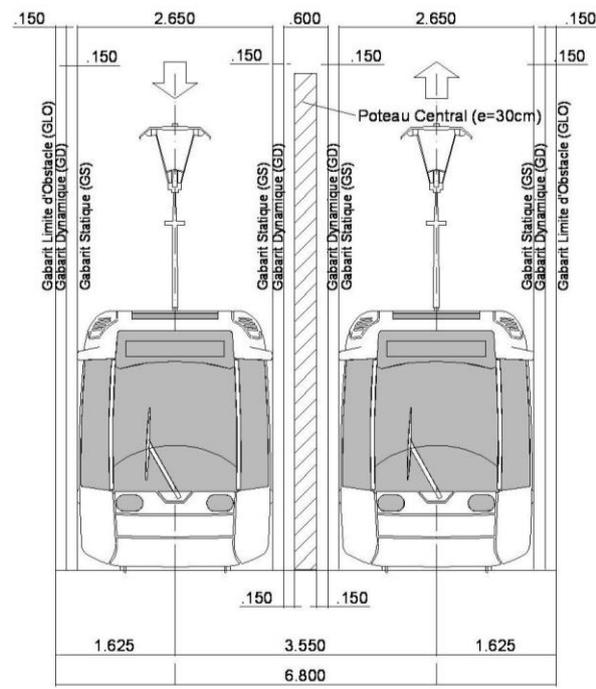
Coupe transversale du tramway en voie double avec poteaux centraux.
